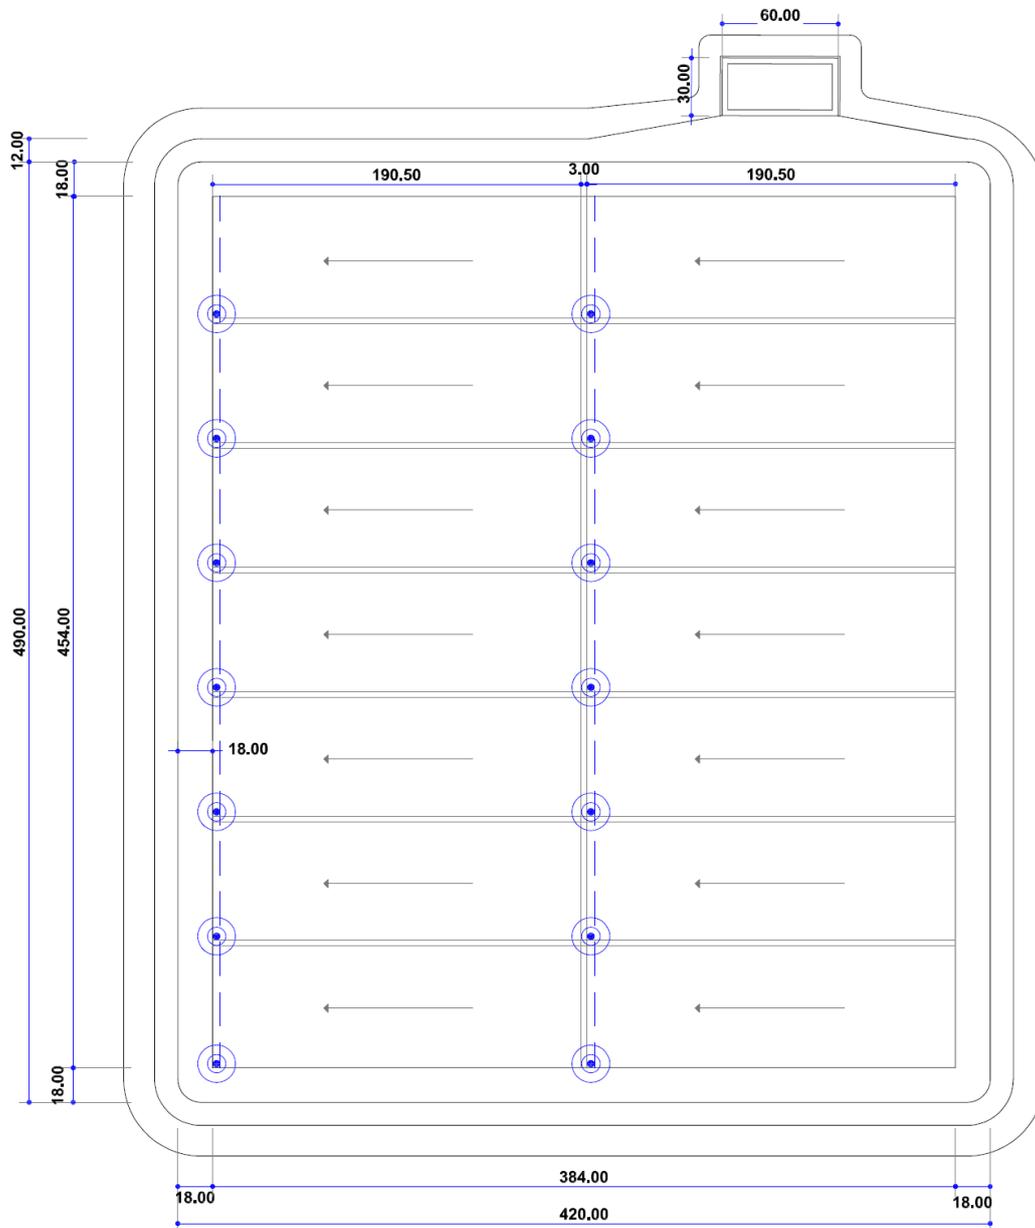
Esquema en planta de división de los sectores y pendiente de fondo de Módulo
